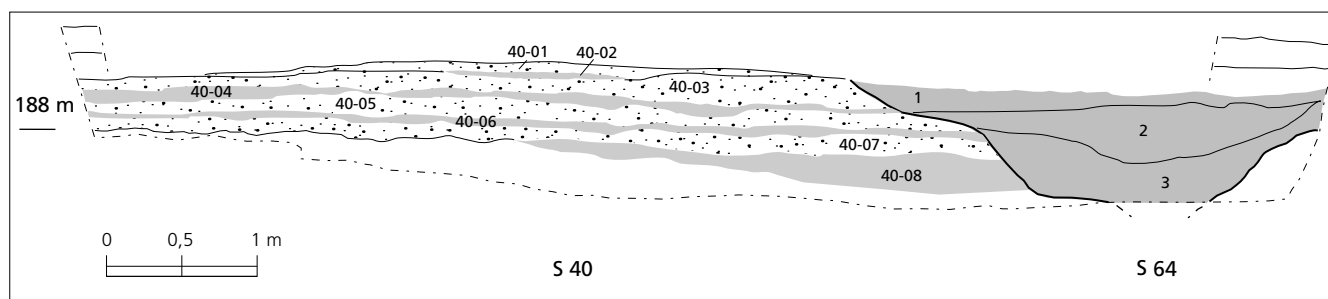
Coupe de la chaussée sortant du camp A, vers le sud (voir fig. 4.9, coupe 52). (DAO M. Reddé).
